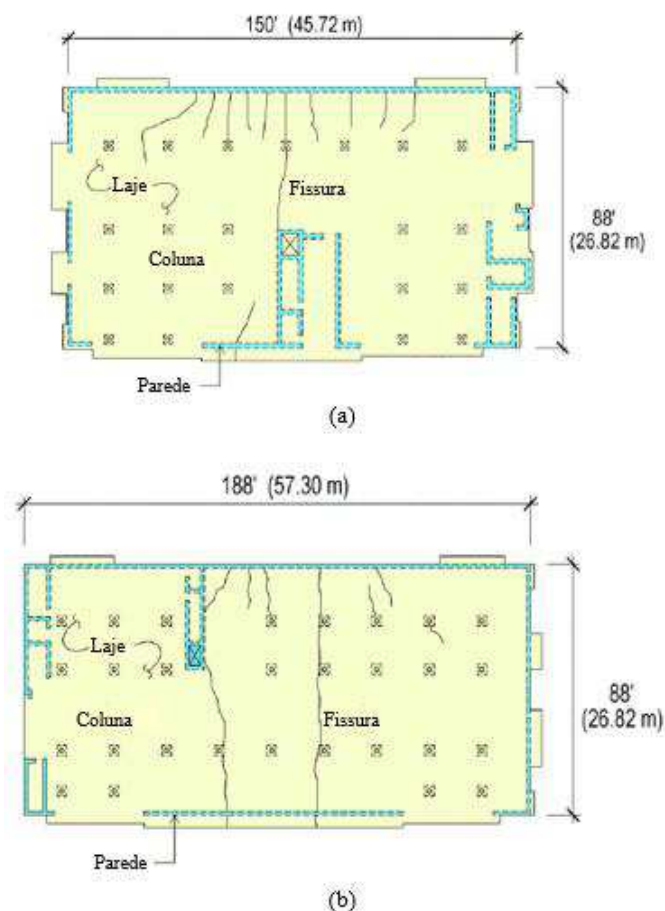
Fissuras de restrição em lajes protendidas e fissuras de flexão em lajes de concreto armado.
